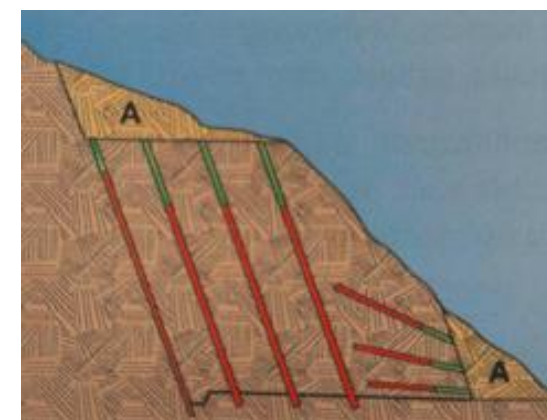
Voladura a media ladera (Fuente: Manual de Perforación, Explosivos y Voladuras, C. López, E. López, P. García)
